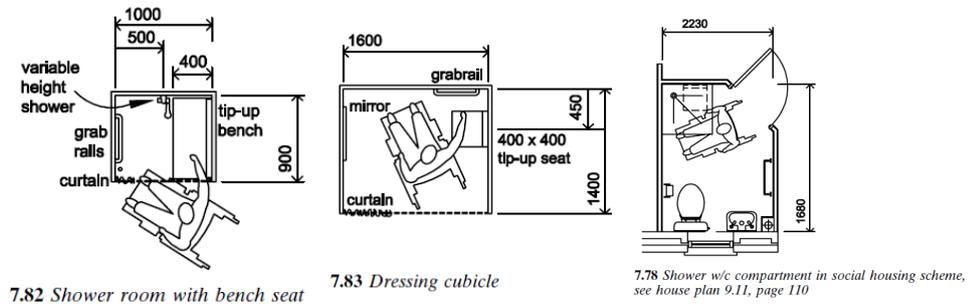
Ruang Gerak Zona Toilet pada Desain
